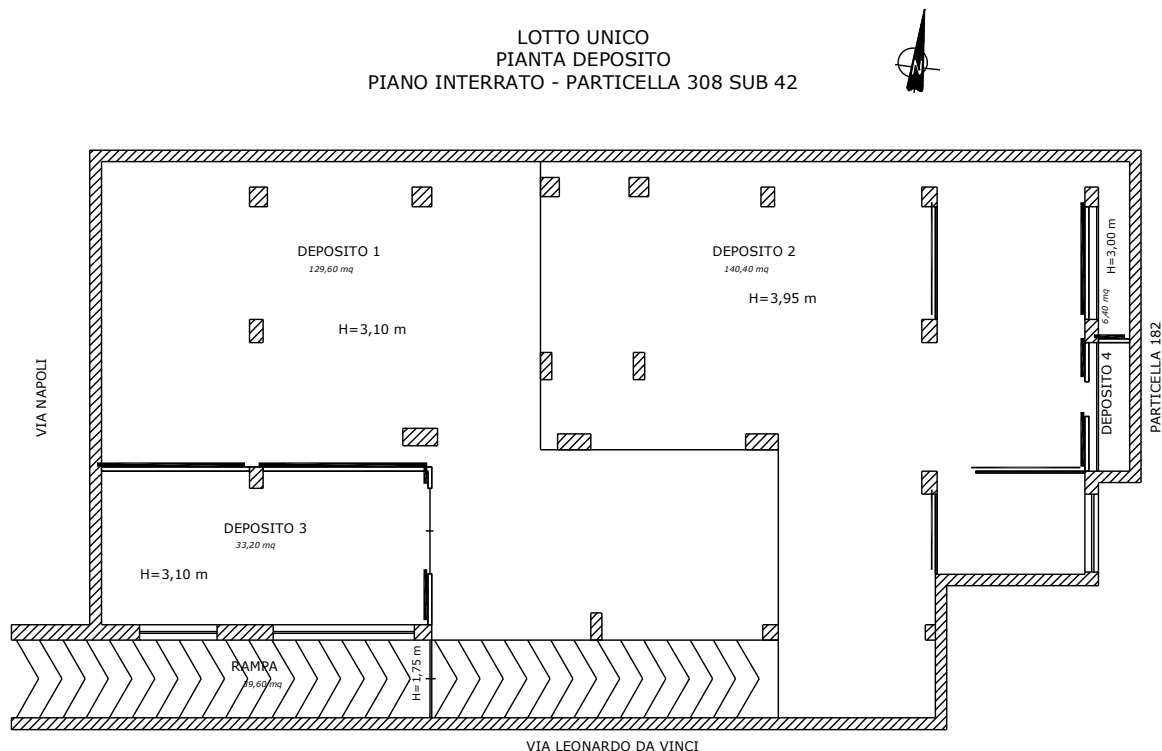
planimetria del deposito al piano interrato con altezze variabili
